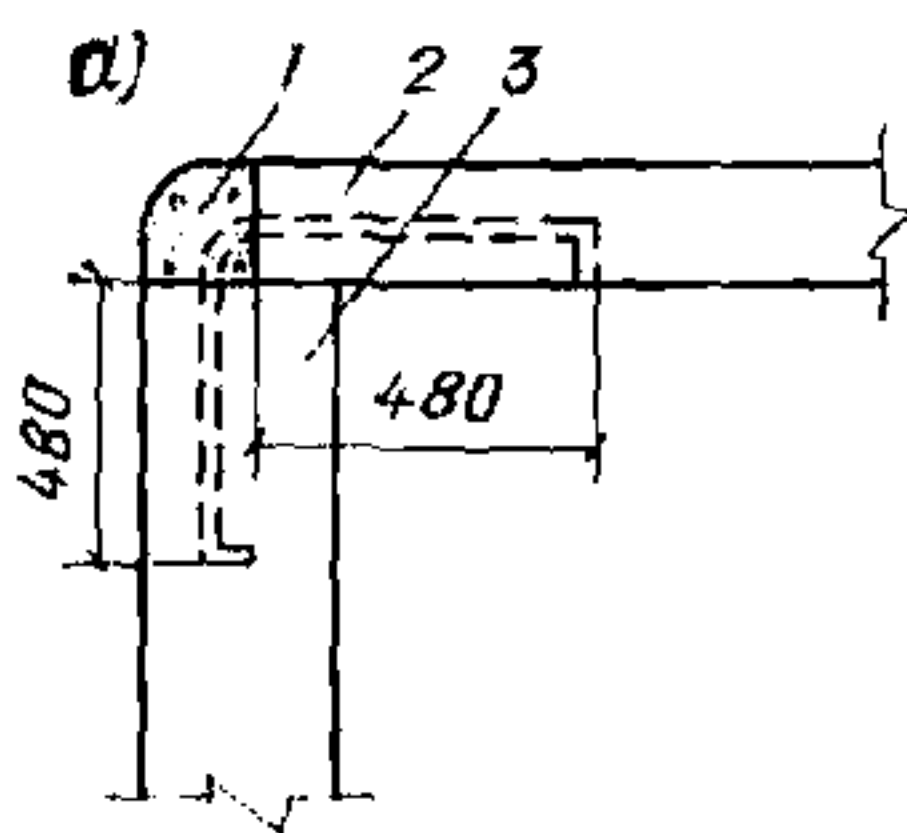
Анкерование элементов перекрытия с наружными стенами
